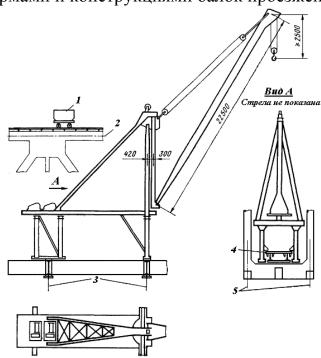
Деррик-кран УМК-2, установленный на проезжей части собираемого пролетного строения моста: 1 – кран-балка для монтажа верхних связей; 2 – ось верхнего пояса главной фермы; 3 – оси поперечных балок проезжей части; 4 – тележка для перемещения крана; 5 – оси главных ферм
